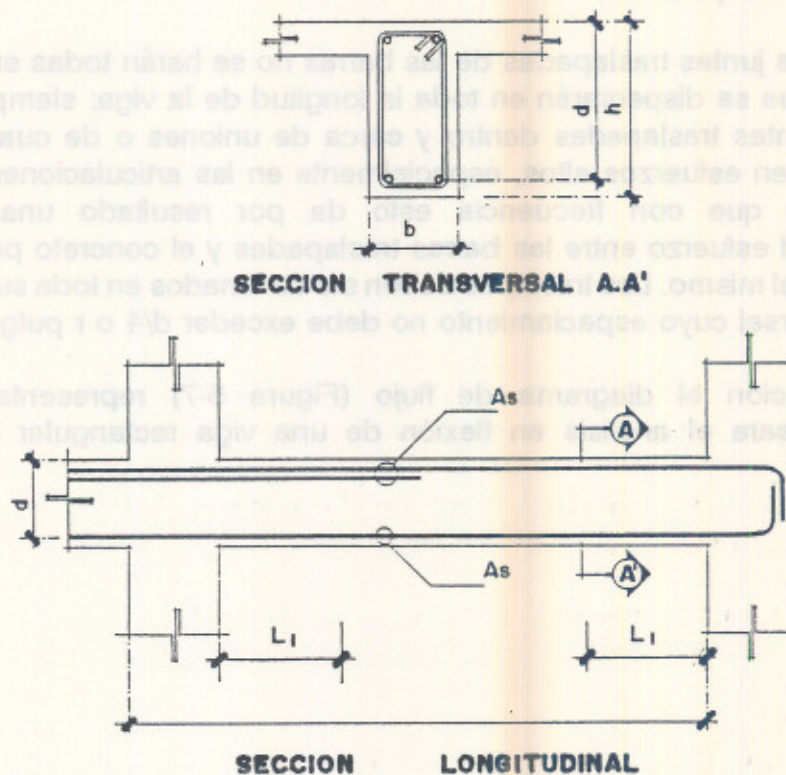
Requisitos para el refuerzo longitudinal de vigas de concreto
